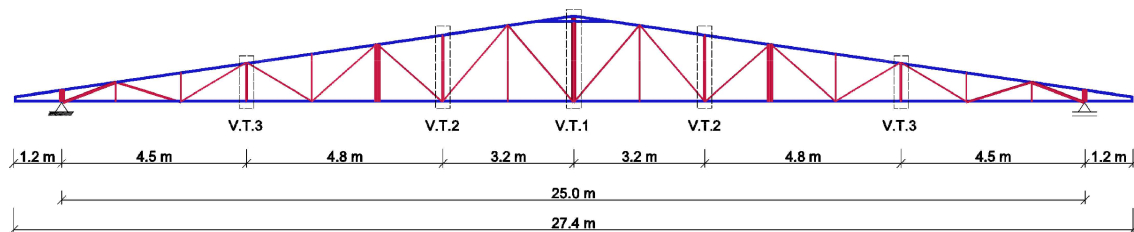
Vigas de travamento entre asnas - vista frontal.
